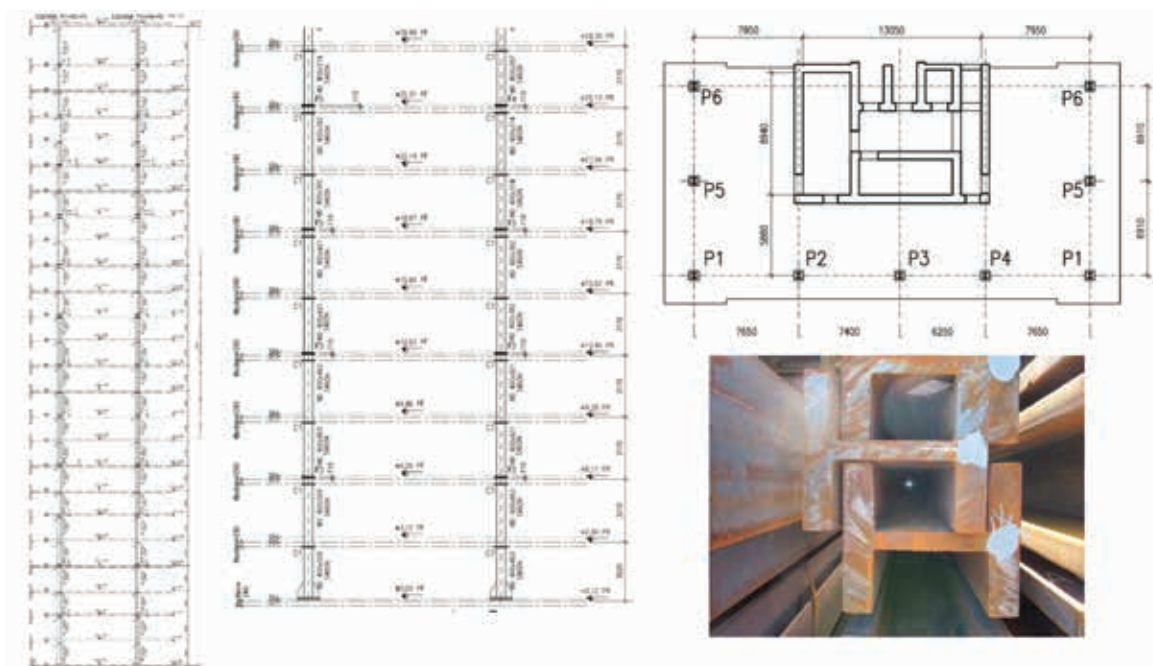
| Torre Giax, Milano – Colonne metalliche e pianta piano tipo
